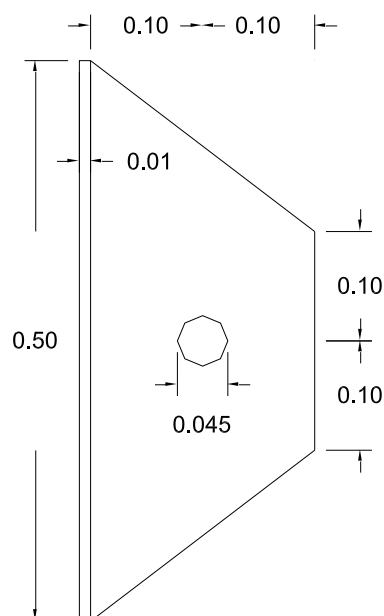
Geometria da chapa de ligação entre arcos e vigas principais. (unidades em [m])
